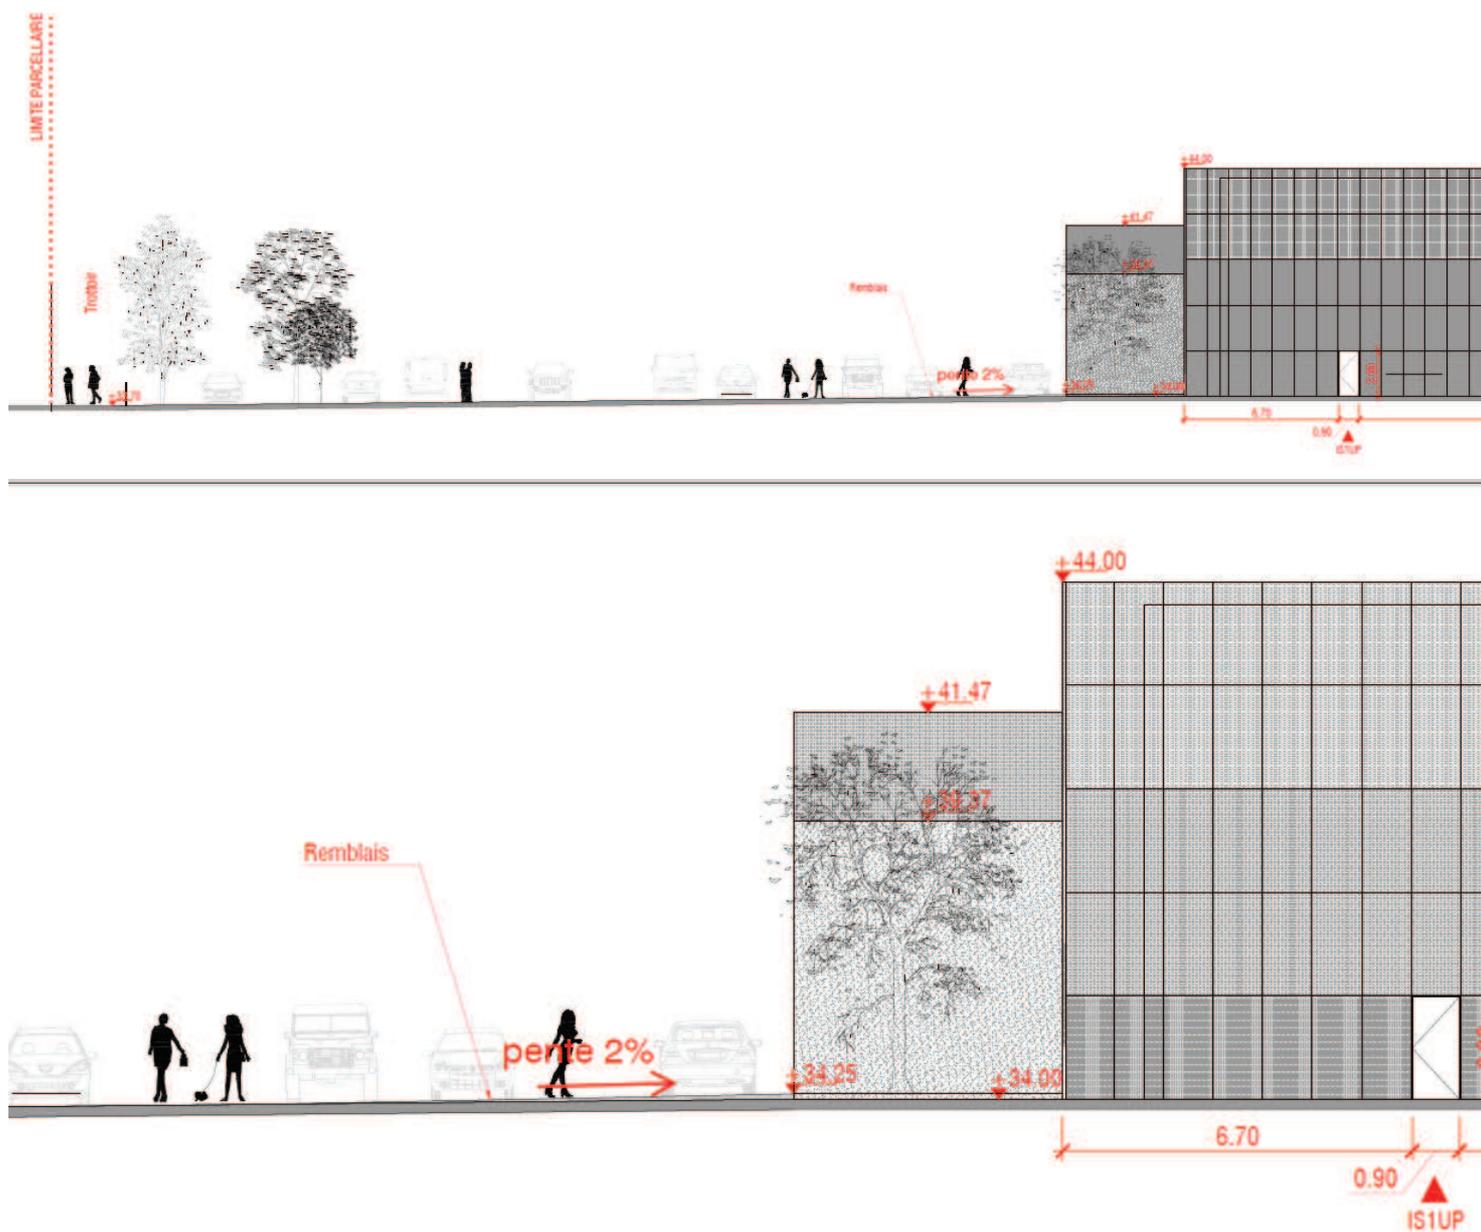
Vue en coupe de la rampe d'accès au supermarché
